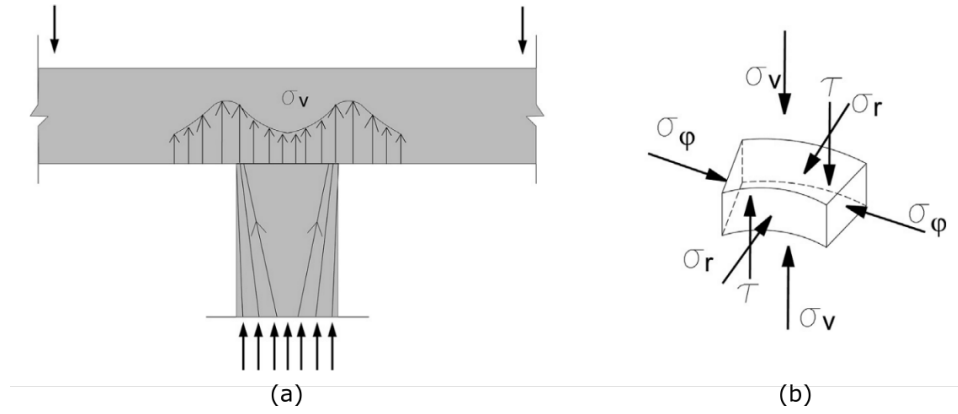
Corte esquemático de las tensiones verticales en la conexión losa-columna (a) y detalle del estado tensional en la misma zona (b) [11].
